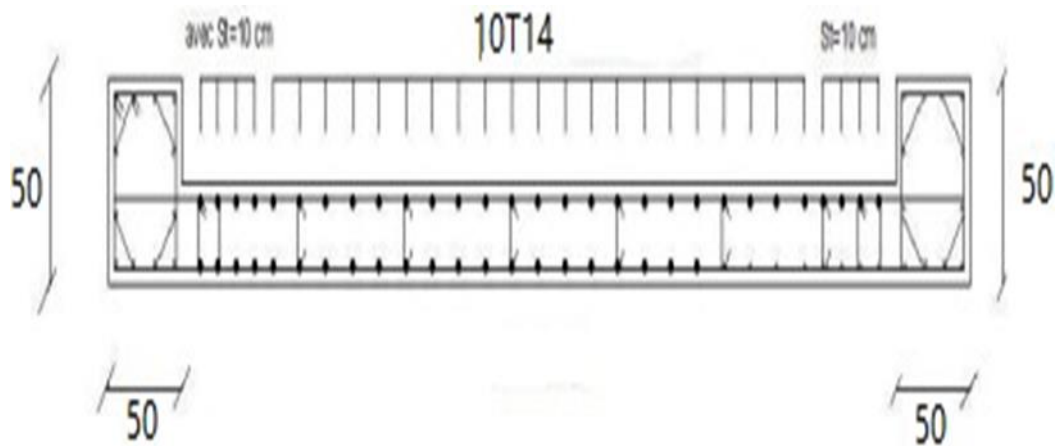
Schéma de ferrailage des voiles les plus sollicités.
